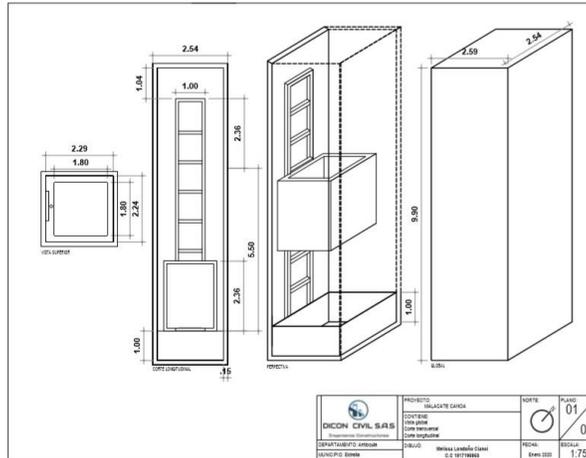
Plano de la obra civil del malacate realizado por el practicante.
